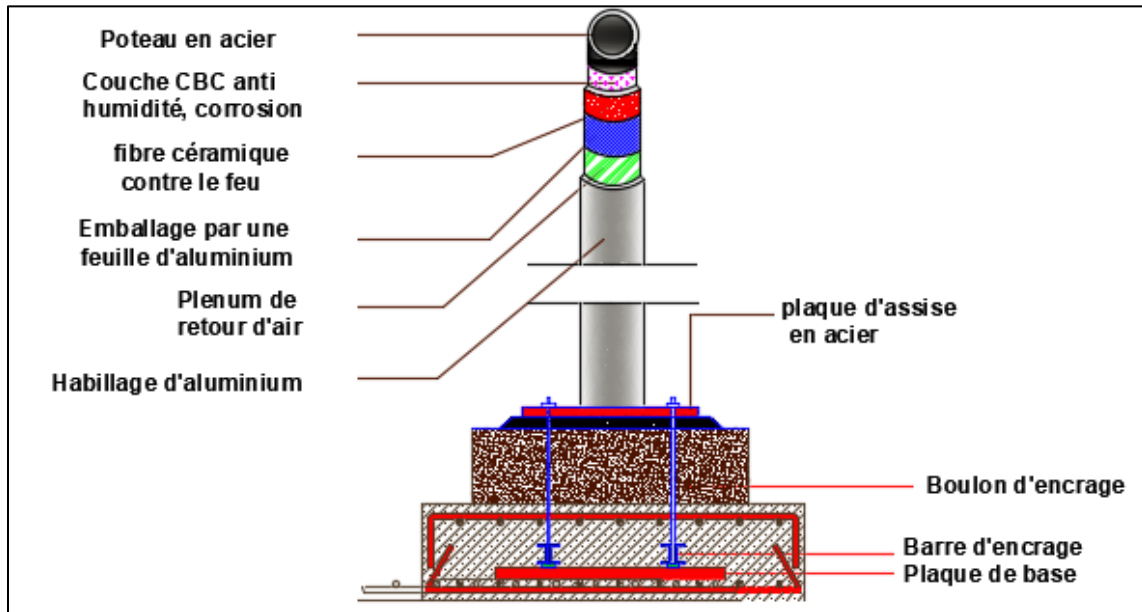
mode d'assemblage entre poteau métallique -fondation Source auteurs
